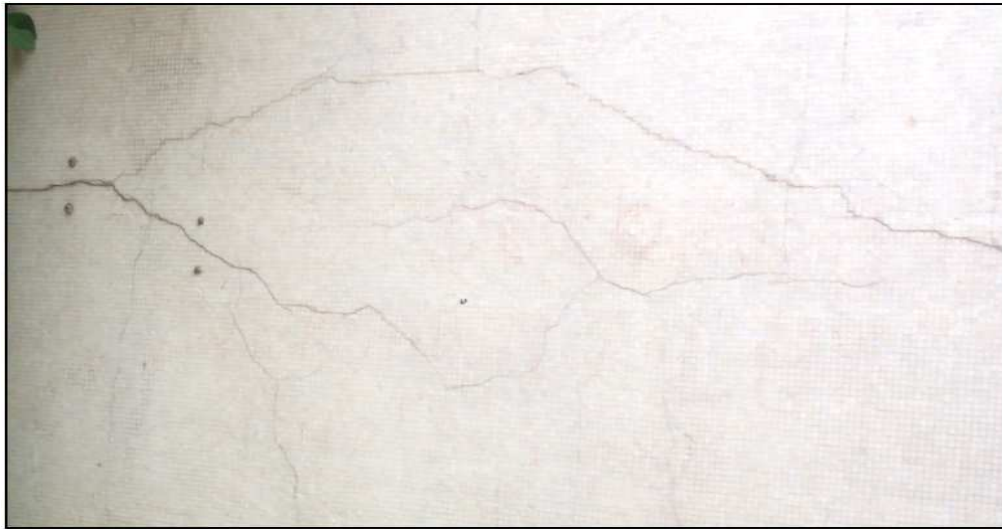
Fotografía de la grieta en la fachada oeste del edificio de la Escuela de Ingeniería Eléctrica
